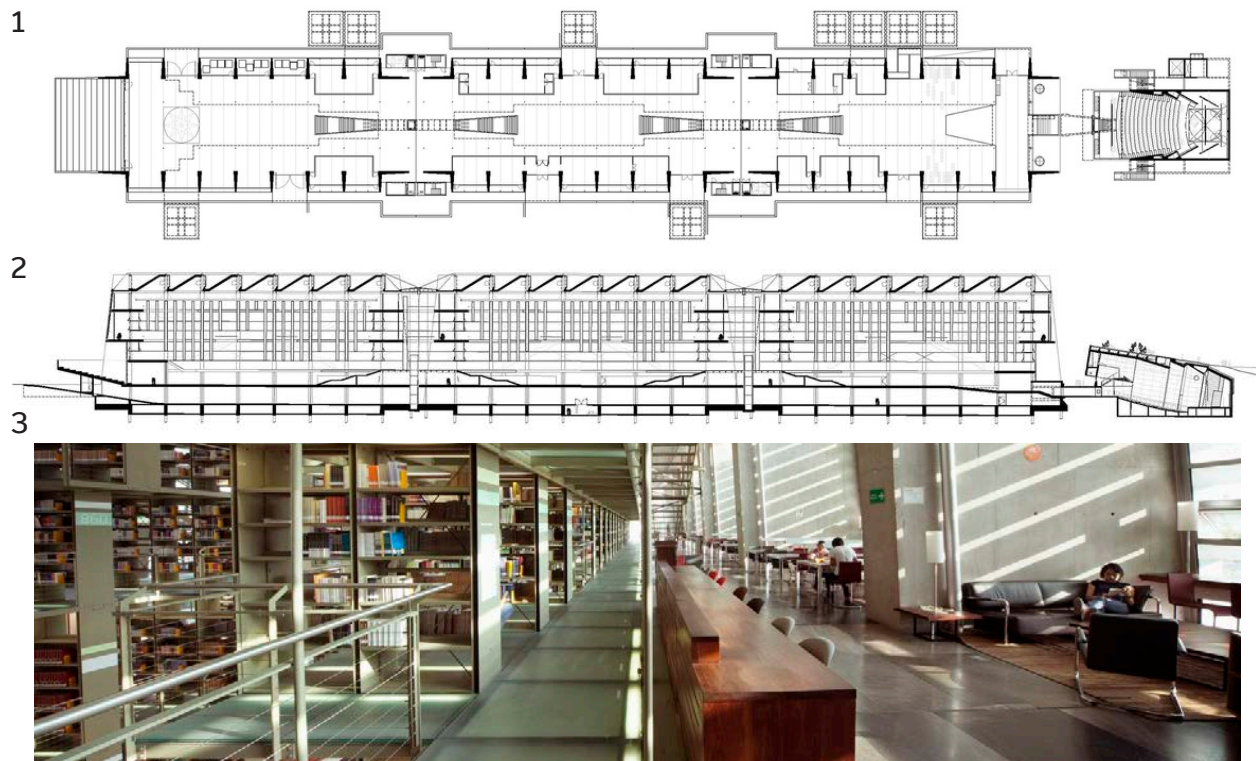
Biblioteca Vasconcelos por Alberto Kalach. Muestra en 1 la planta arquitectónica, 2 corte longitudinal, 3 vista del interior. Recuperado 2020 de: <https://www.archdaily.mx>
